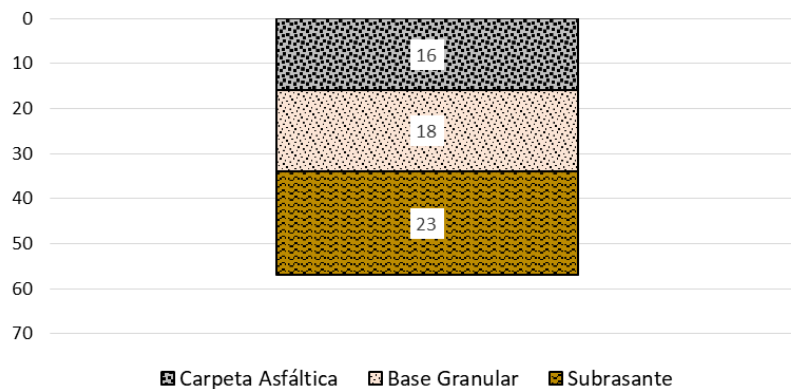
Estructura de Pavimento Flexible Propuesta
